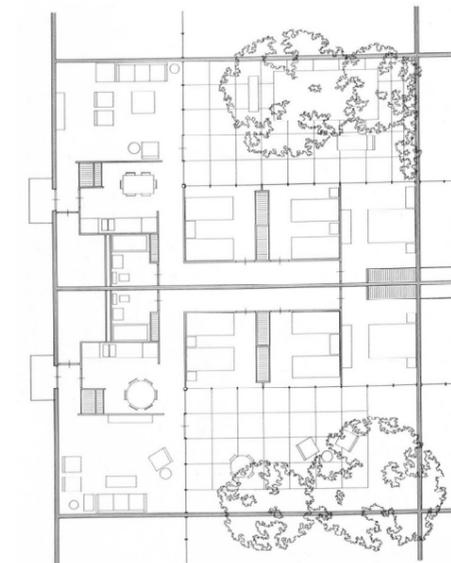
Grundriss: Hofhaussiedlung in Chicago, 1967
